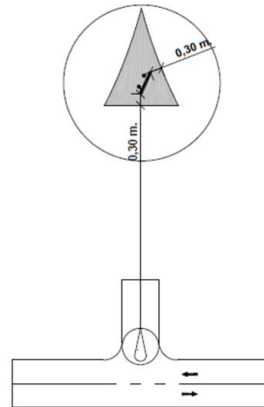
Croquis posició transversal de cartells fletxa en illeta, segons Instrucció de Carreteres 8.1.1.C.
